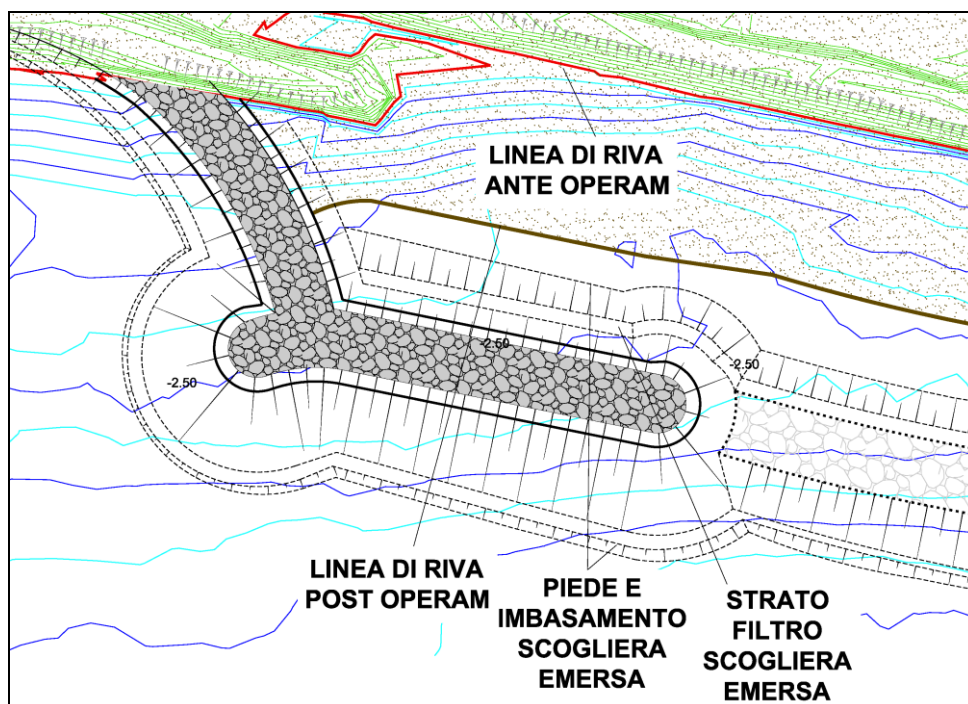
Dettaglio planimetria di progetto della modifica apportata alla prima scogliera emersa
